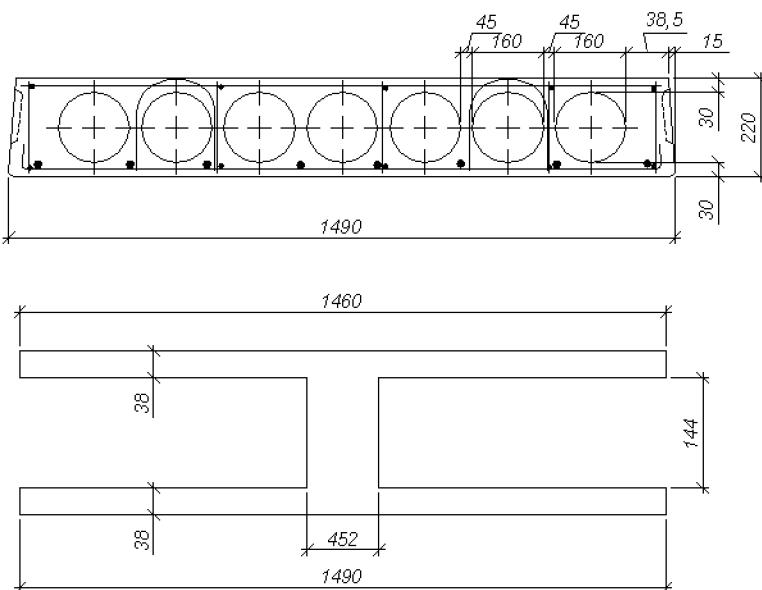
Поперечний переріз плити з круглими порожинами.
